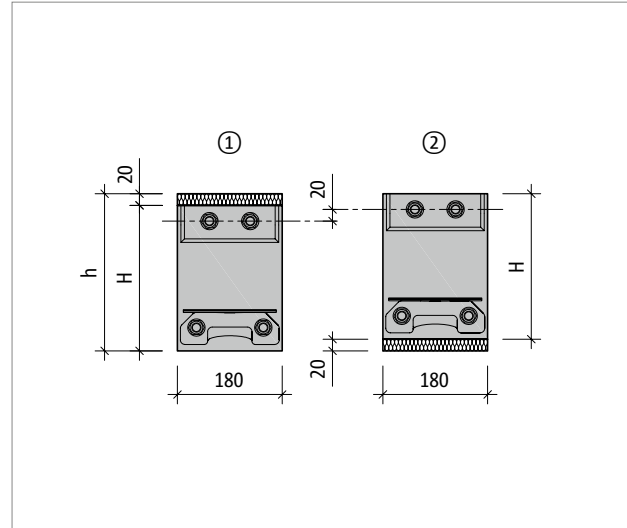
Schöck Isokorb® T type SK : disposition avec décalage en hauteur
